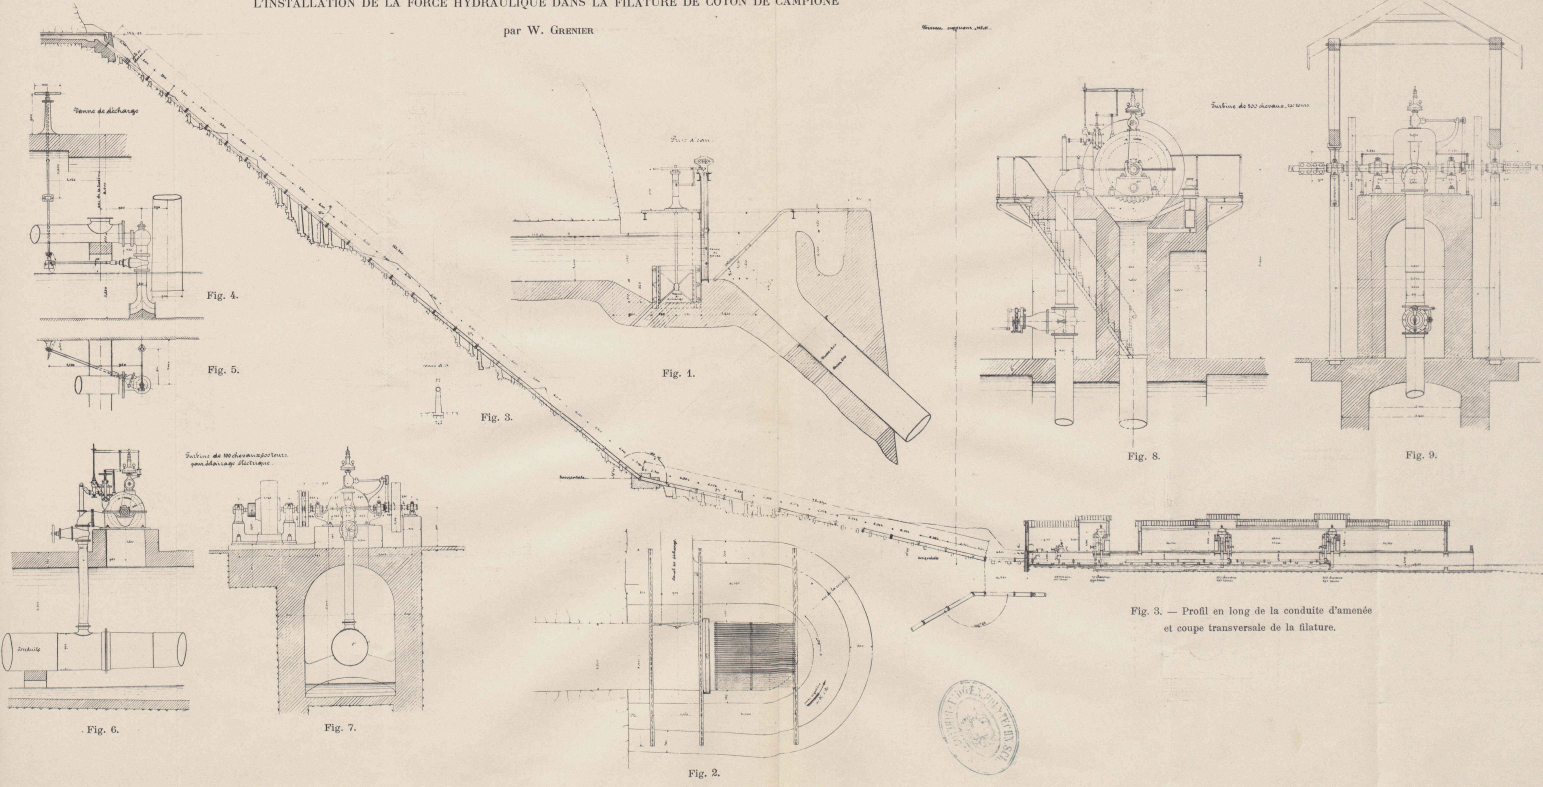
Profil en long de la conduite d'aménée et coupe transversale de la filature.
